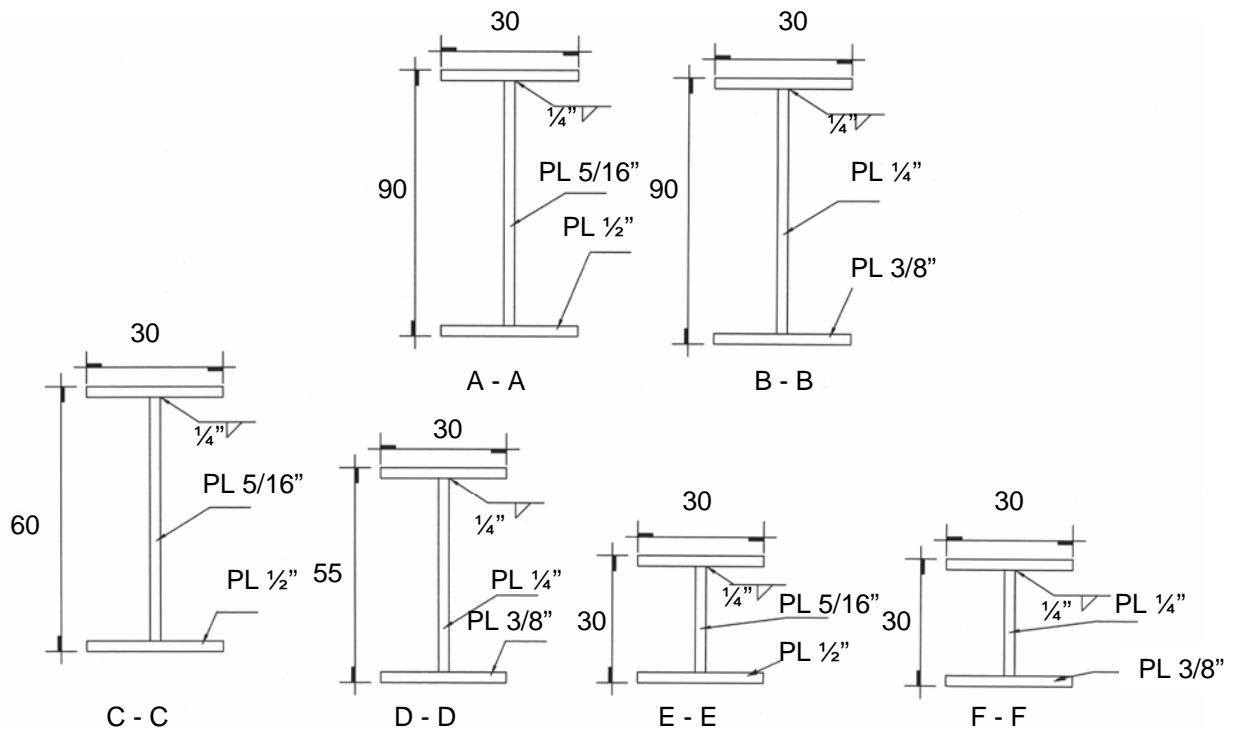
Secciones de marcos con especificaciones de dimensiones y espesores de placa, así como detalles de aplicación de soldadura
